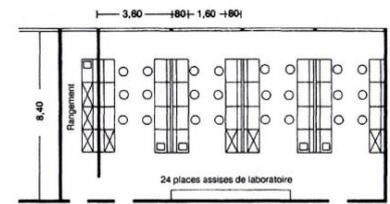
Plan d'un laboratoire d'enseignement et de travaux pratiques. (Ernst Neufert 10^e édition française, Les éléments des projets de construction, pp 248)
